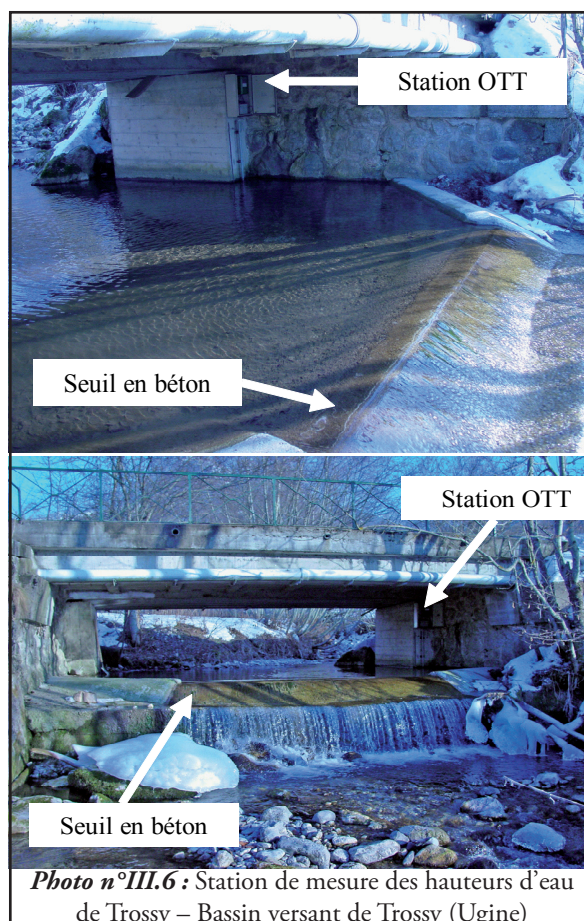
Station de mesure des hauteurs d'eau de Trossy – Bassin versant de Trossy (Ugine)
